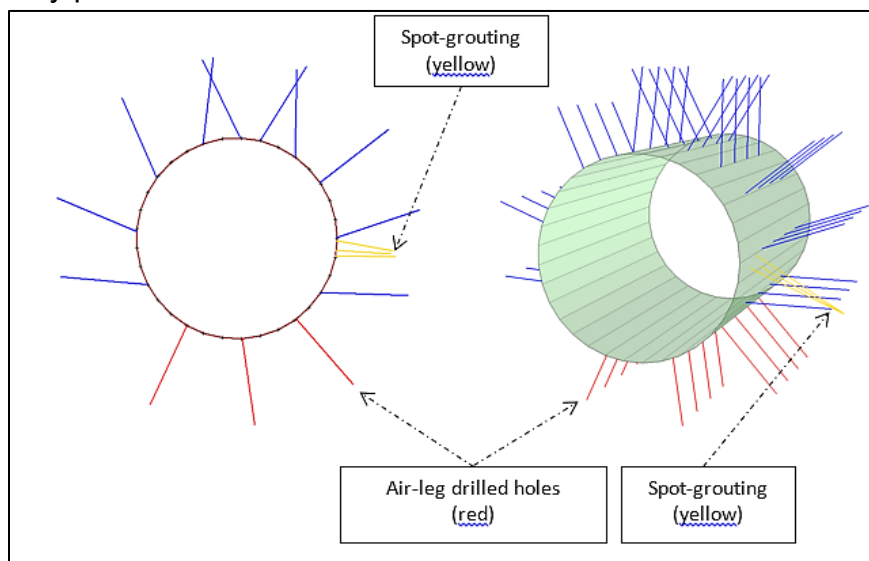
Ejemplo de patrón de diseño de grouting de post-excavación y spot-grouting complementario para TBM
